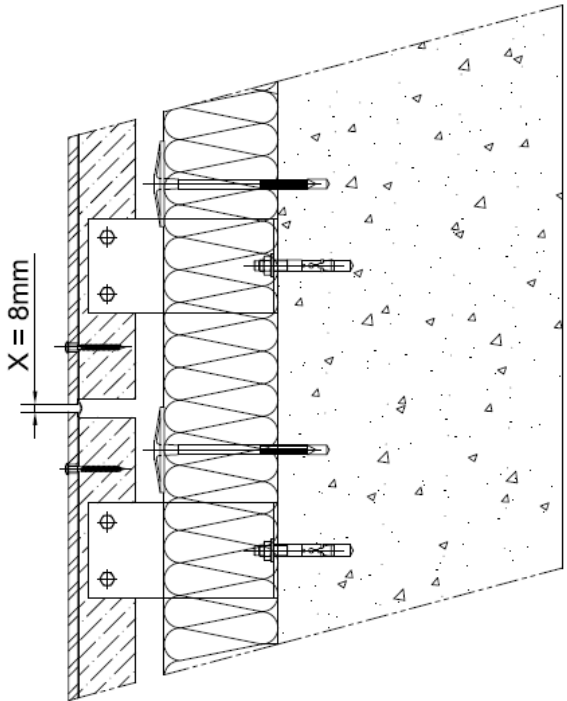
Sección vertical. Junta horizontal entre paneles sin perfil auxiliar con banda de protección.
